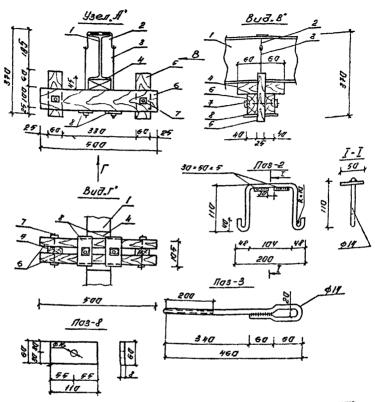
Подвесная опора и хомут. Вариант по металлическим балкам перекрытия.
